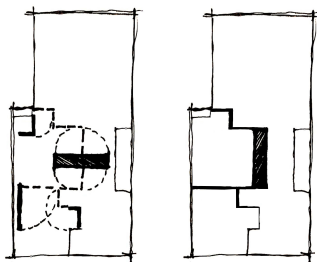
Esquema em planta dos movimentos pivotantes dos painéis e paredes do apartamento. Desenhos do autor.
